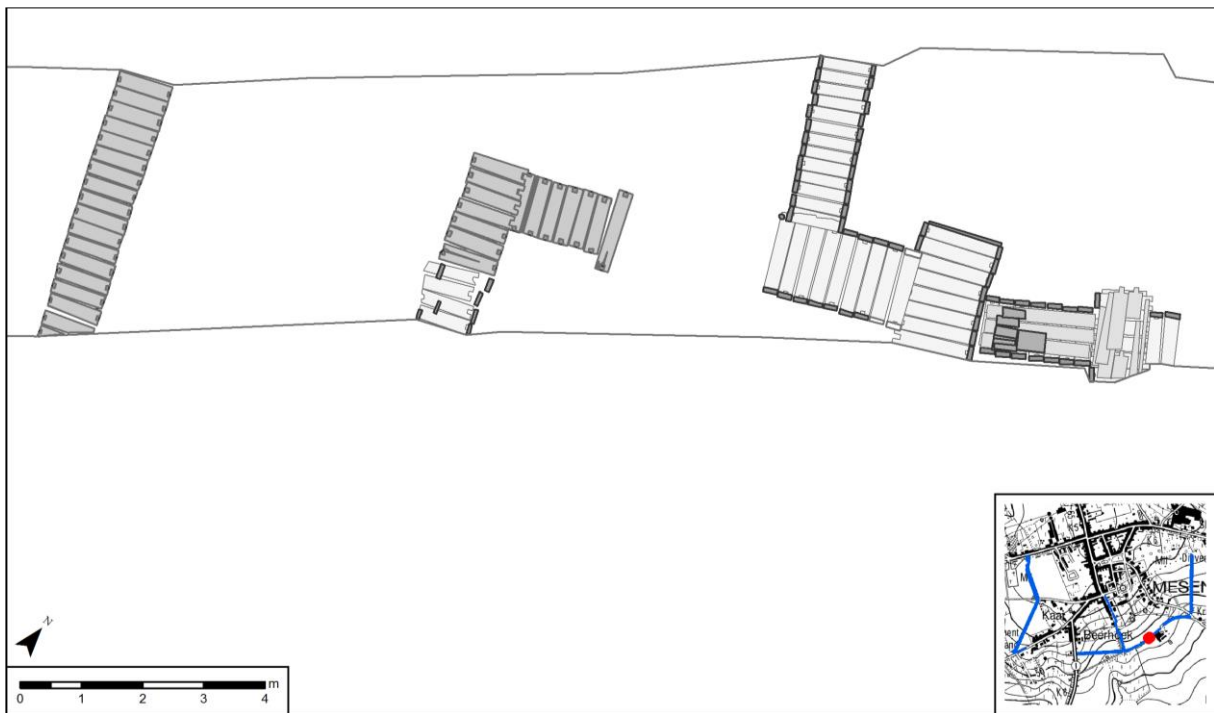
Overzichtsplan van de vier tunnels aangetroffen ten zuiden van Mesen (uit: Verdegem 2013).
